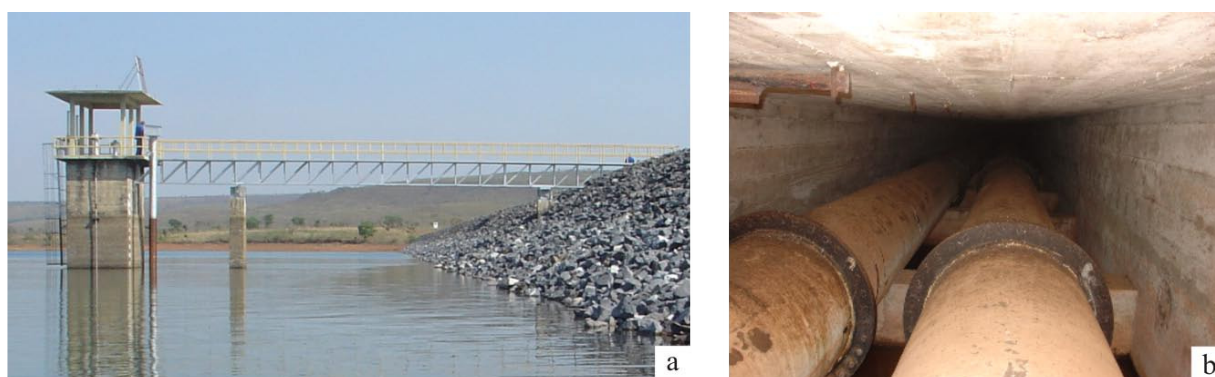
Estrutura de captação e adução da barragem de Santa Maria: a) foto da torre de tomada d'água; b) foto do interior da galeria sob a barragem - jusante para montante.
